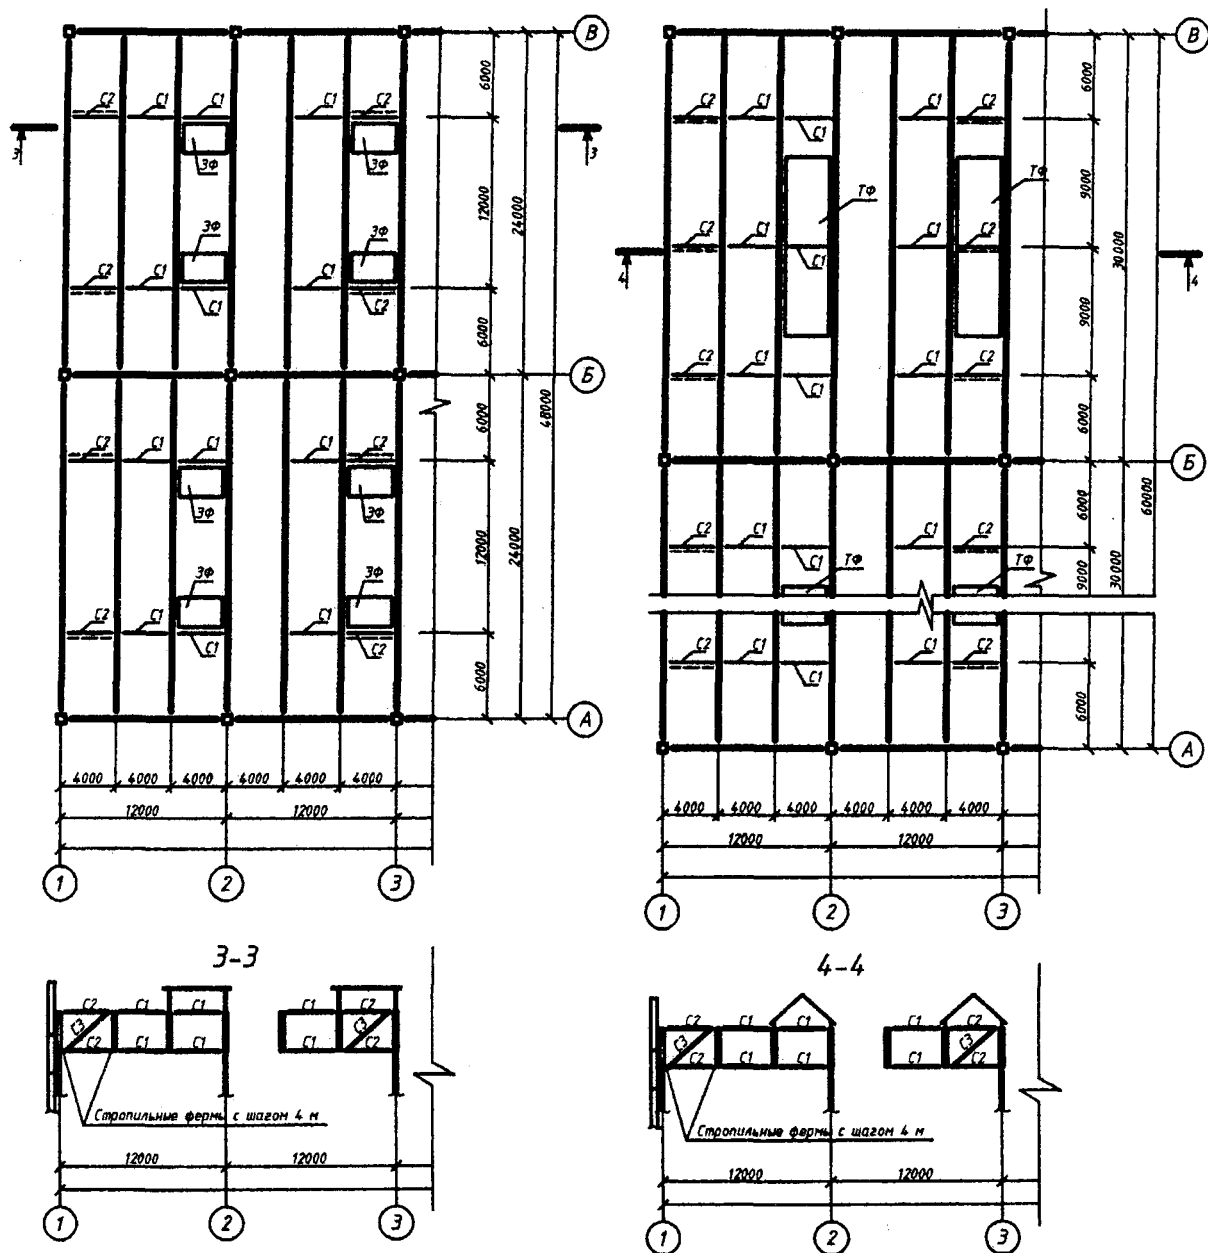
Схема расположения элементов покрытия в зданиях с зенитными и треугольными фонарями при блочном монтаже
